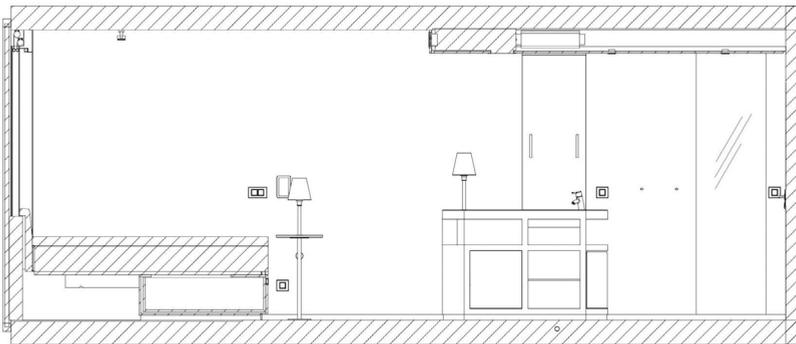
; Schnitt & Grundriss Modul, CitizenM, London - Concrete Architecture
